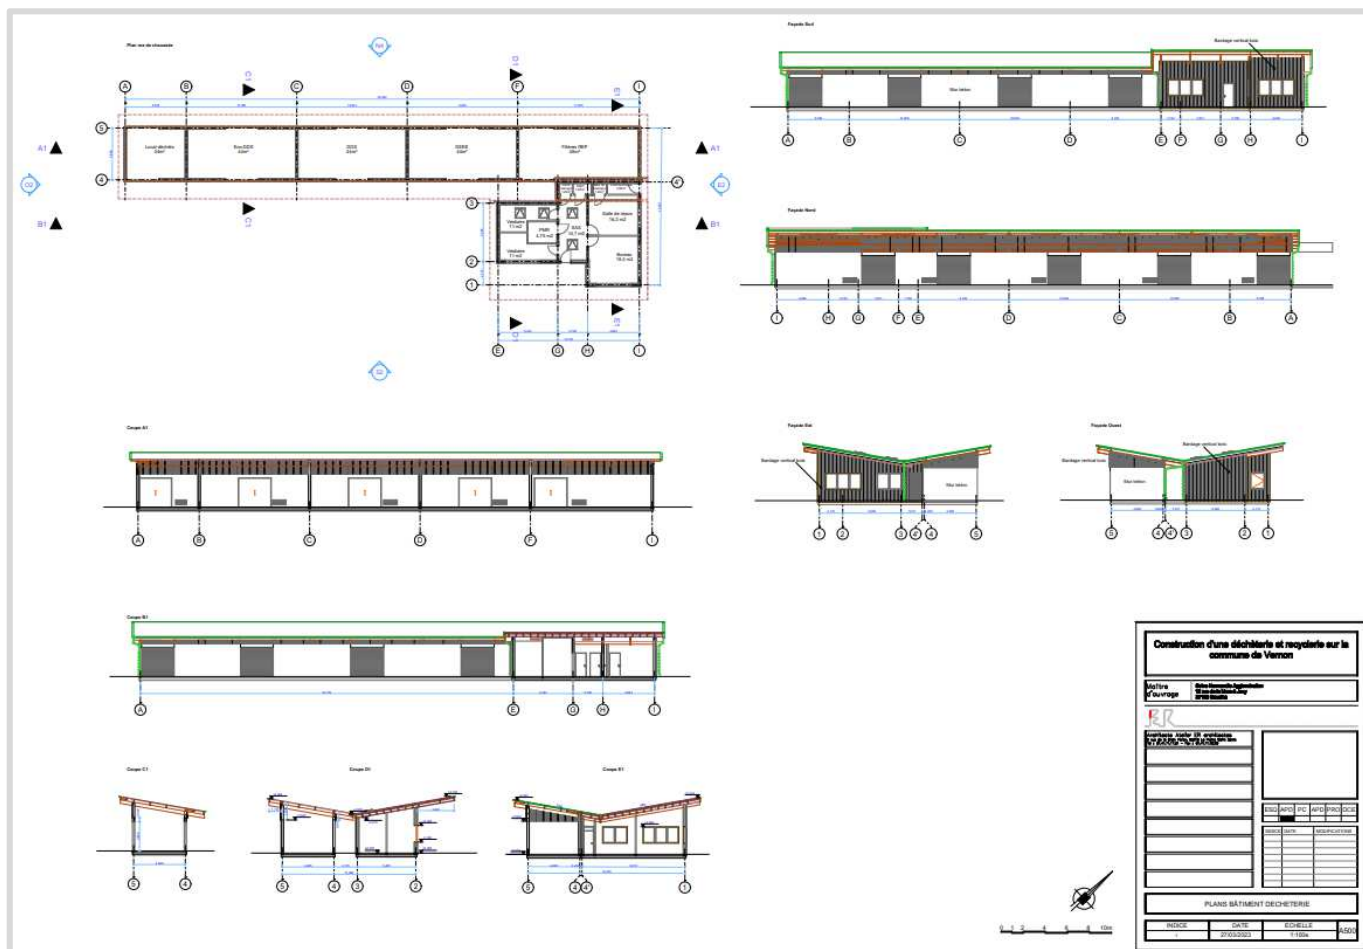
plan du bâtiment de la déchetterie (source Architecte ER).
